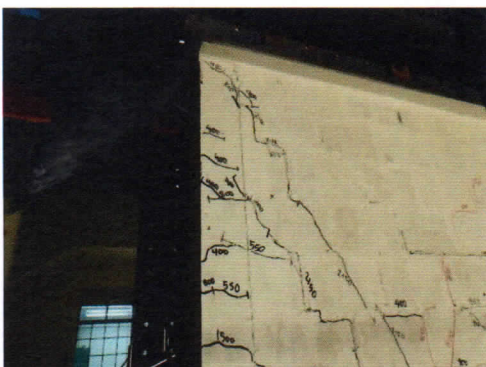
Nuevas grietas horizontales en la columna para una distorsión 1/400 Vista cara Sur.
